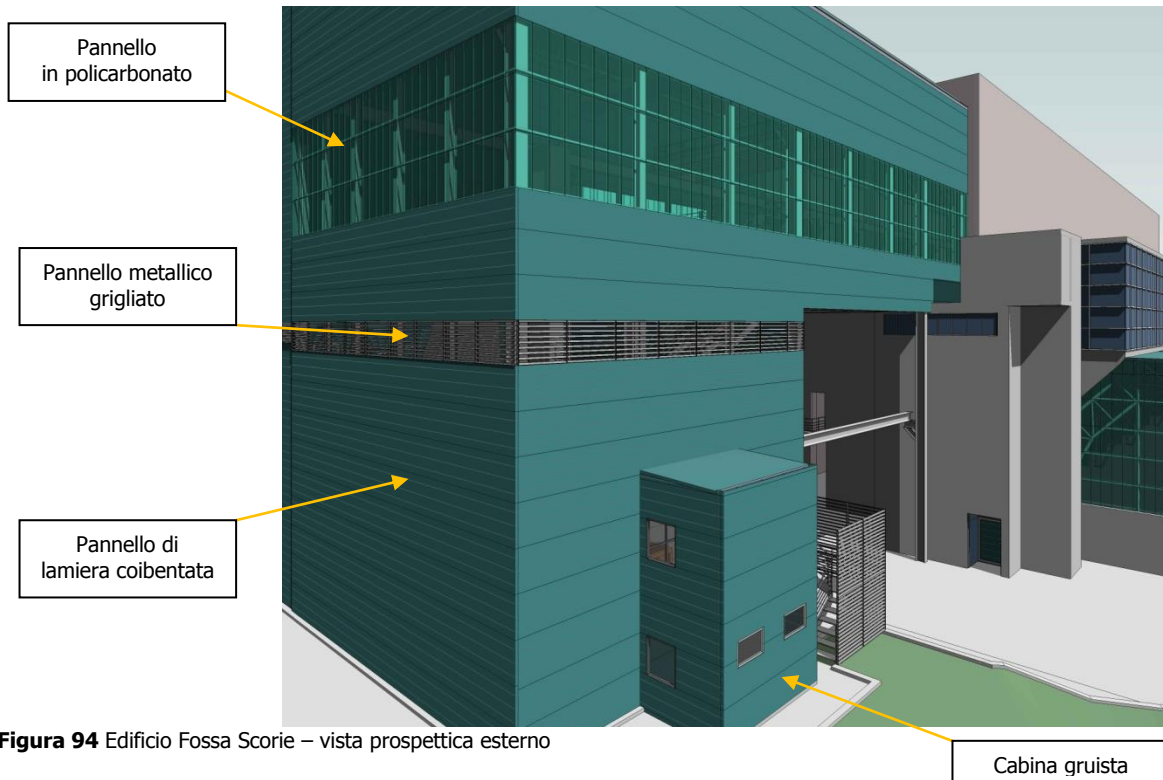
Edificio Fossa Scorie – vista prospettica esterno
